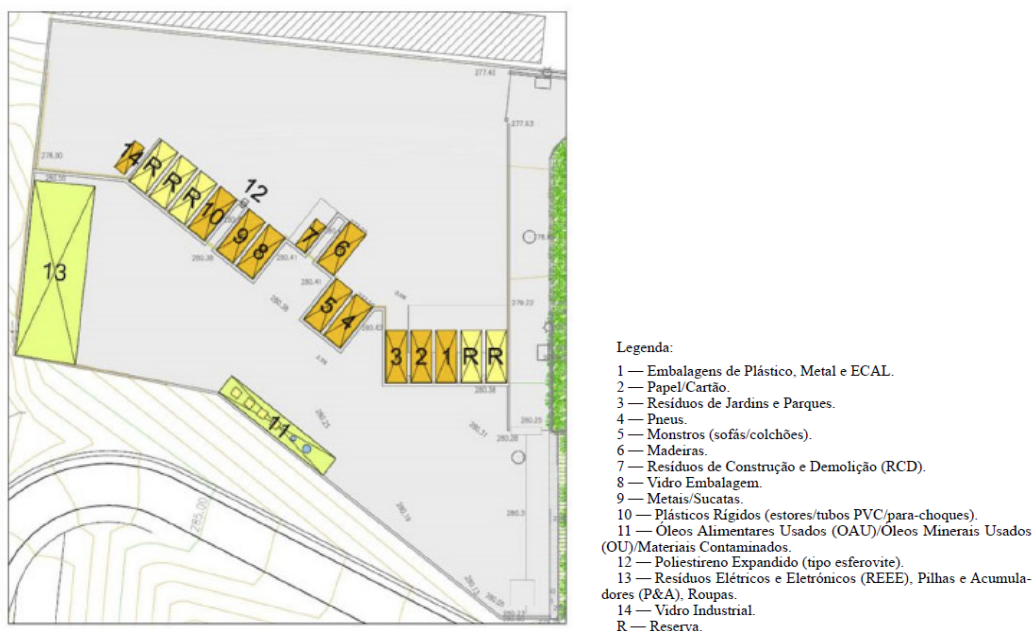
Planta das instalações do Ecocentro da Abrunheira
